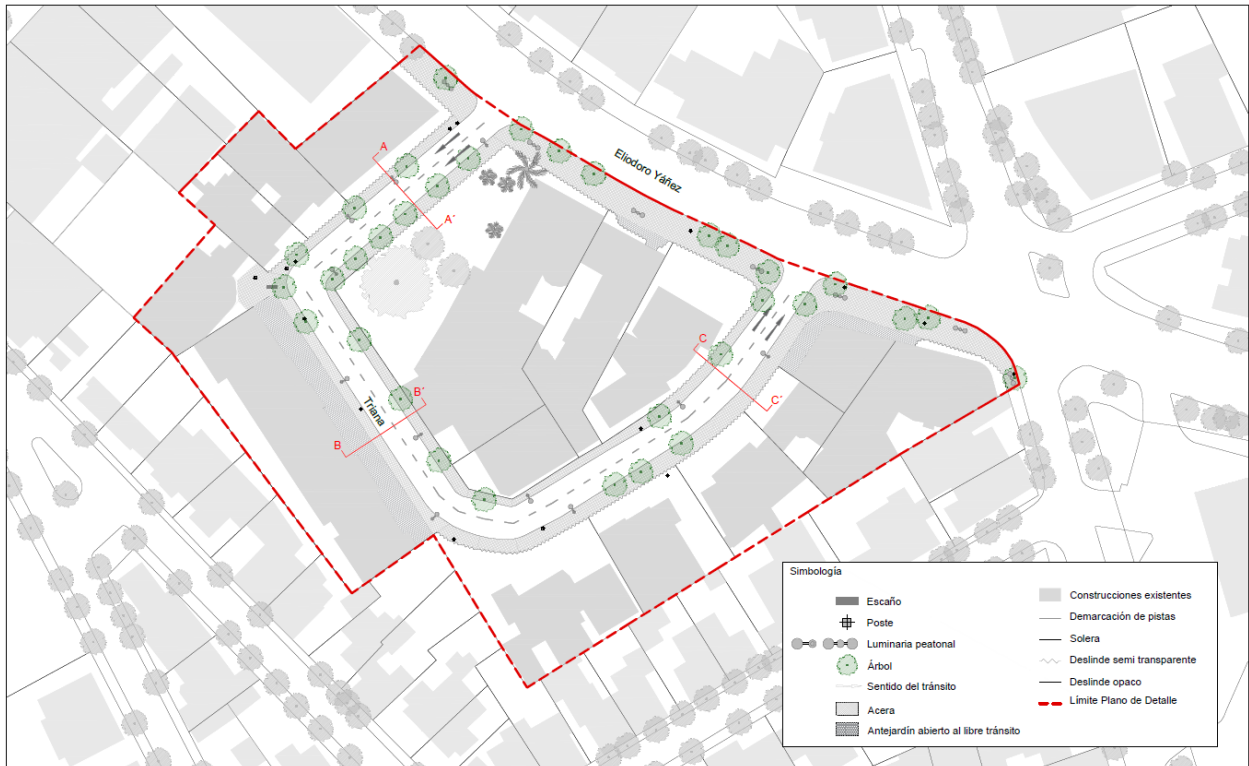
Espacio Público, situación existente. ZCH Conjunto calle Triana. Fuente: Elaboración propia.
